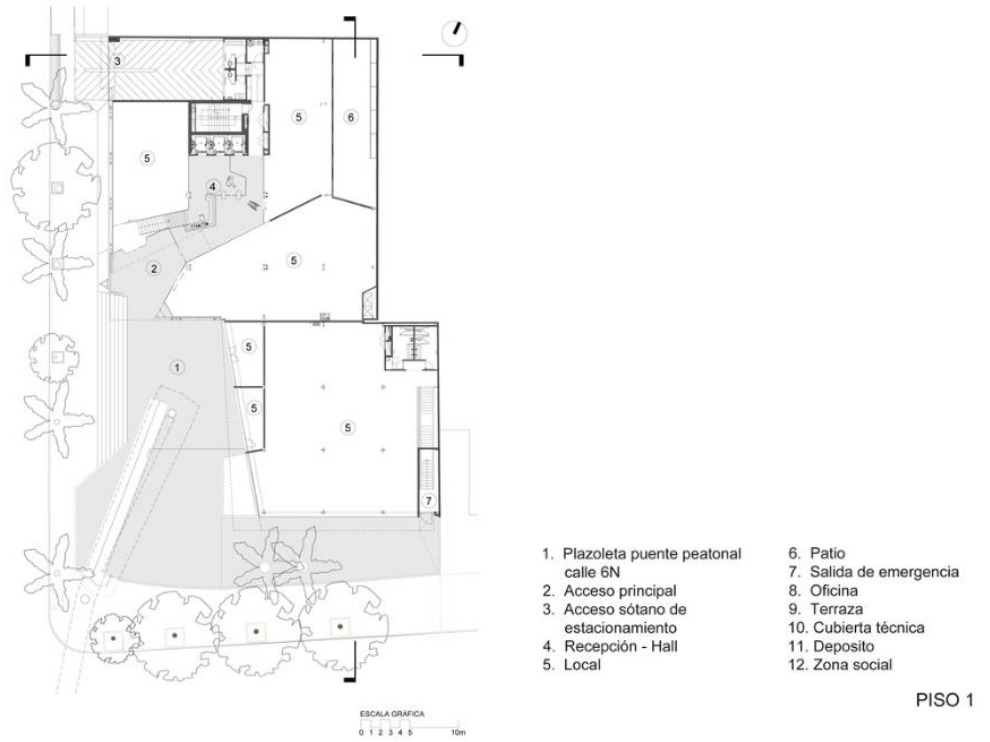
Plano arquitectónico del primer nivel del Centro empresarial Torre centenario, Cali. Elaborado por BYE Arquitectos
